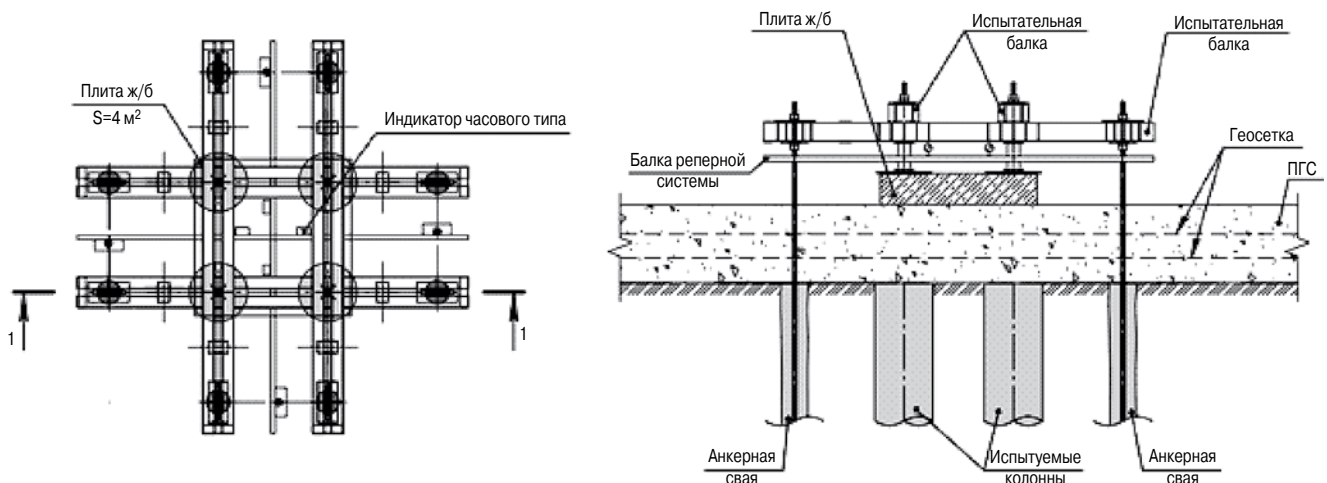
Схема испытания укрепленного грунта штампом для схемы укрепления № 1
